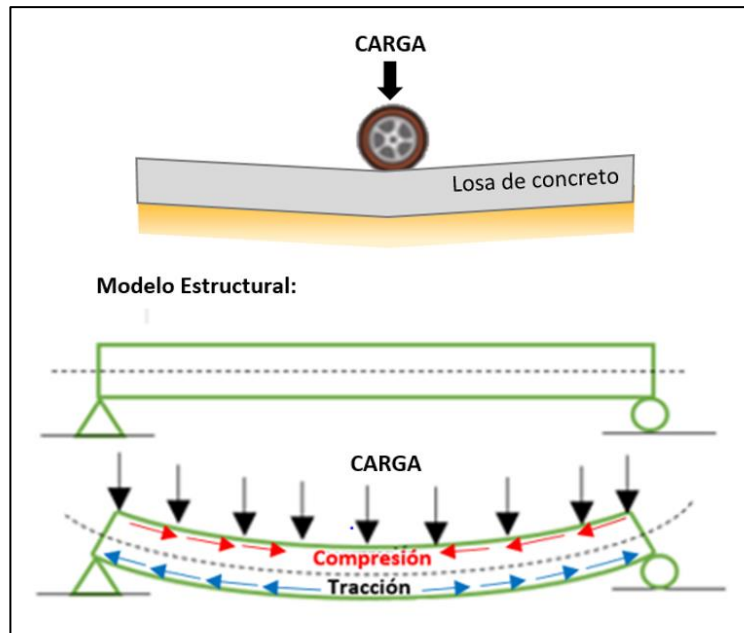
Modelo estructural simplificado de un pavimento rígido
